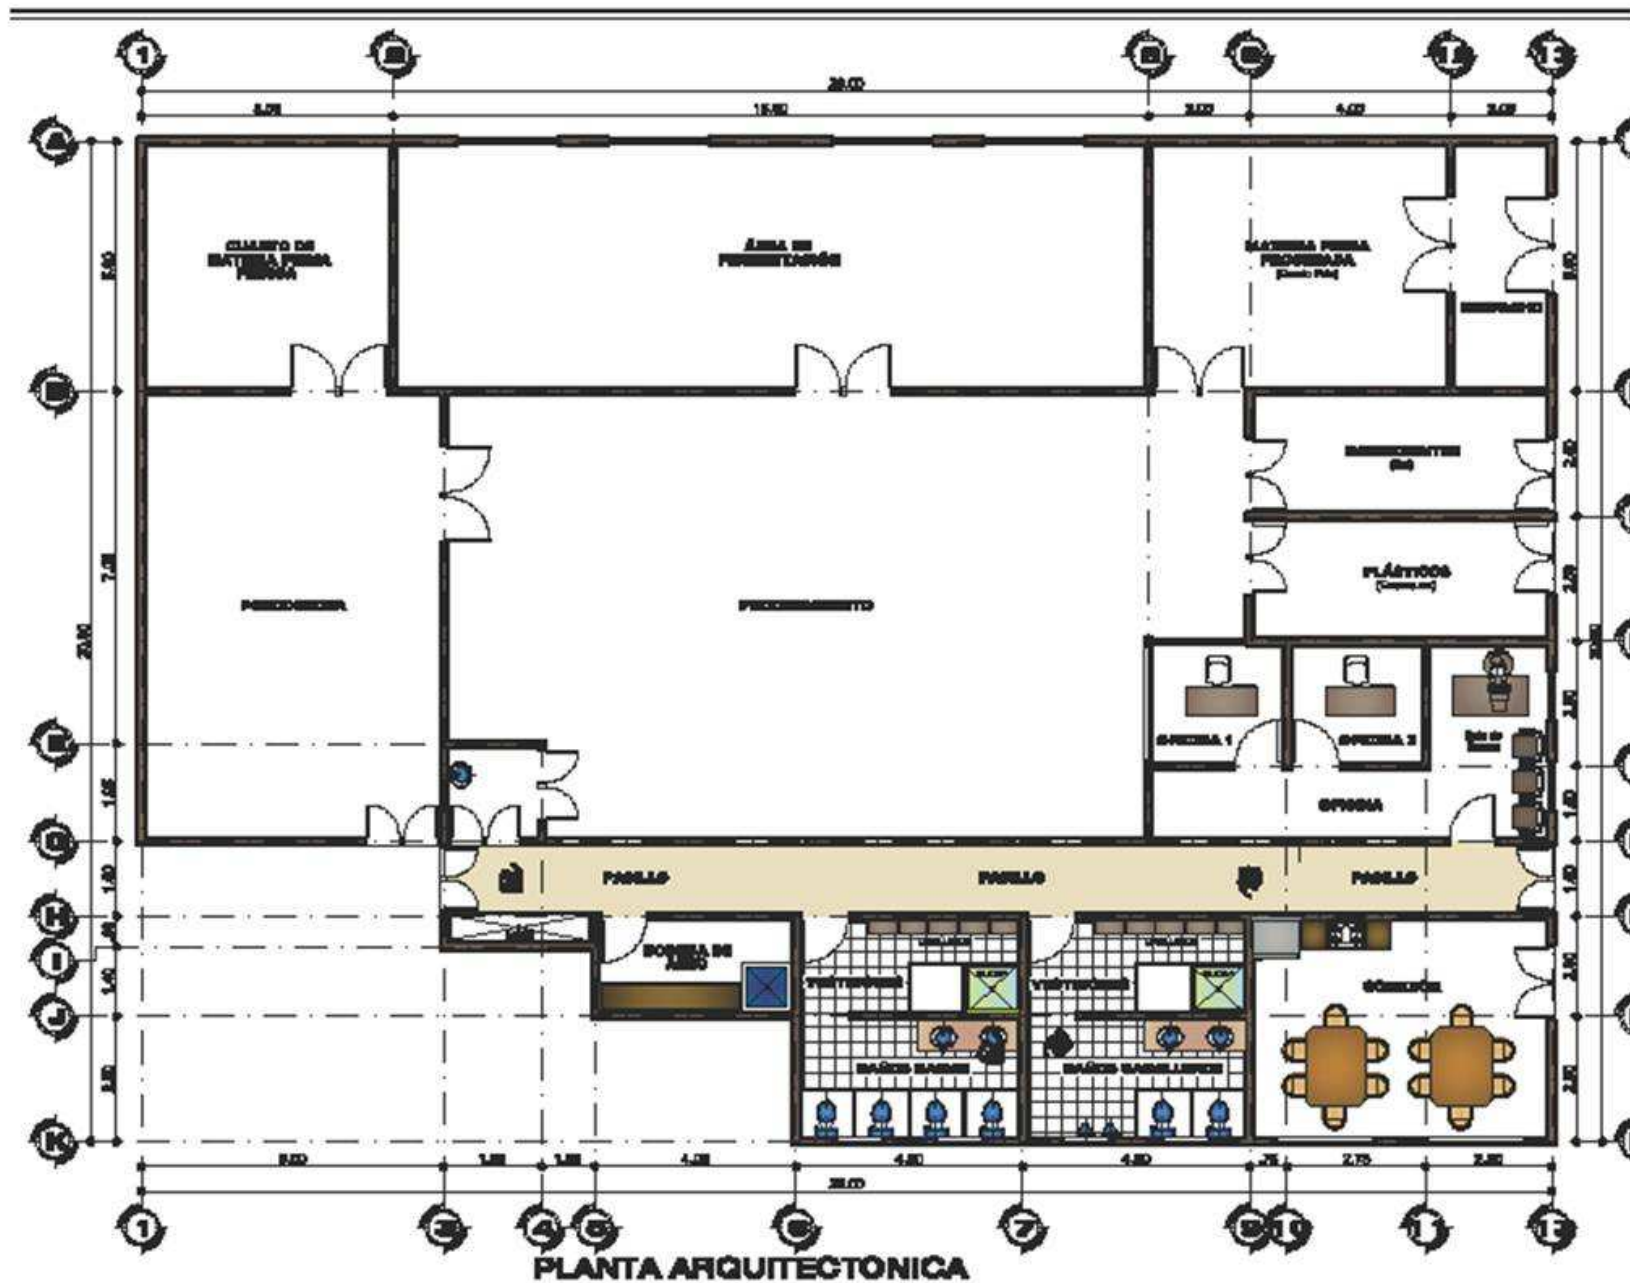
Diseño arquitectónico de planta: áreas y dimensiones
